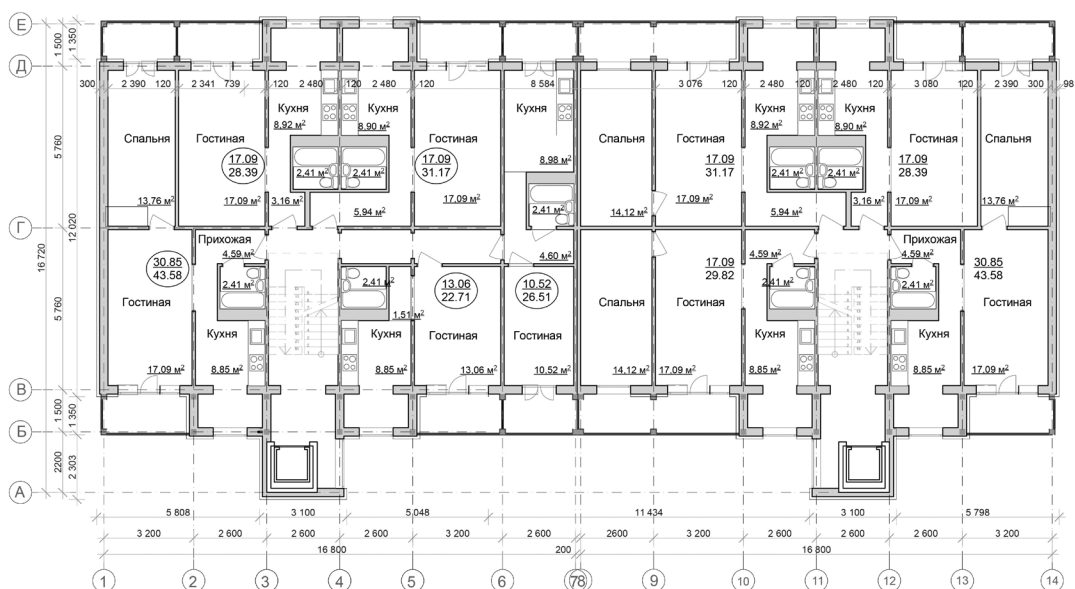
План первого и типового этажа. Реконструкция с надстройкой мансардных этажей
